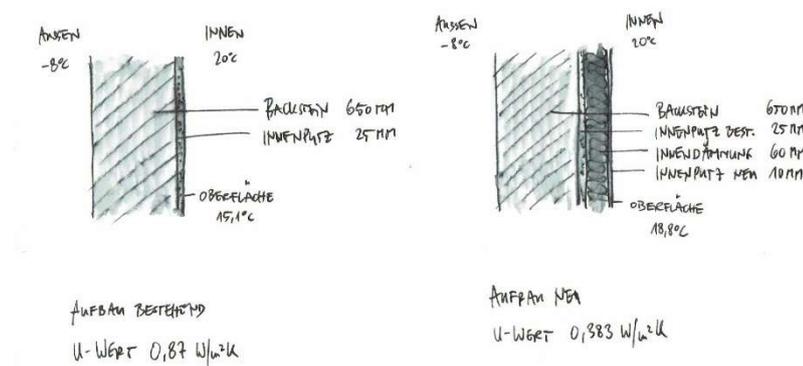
Skizze Wandaufbau bestehend und gedämmt
